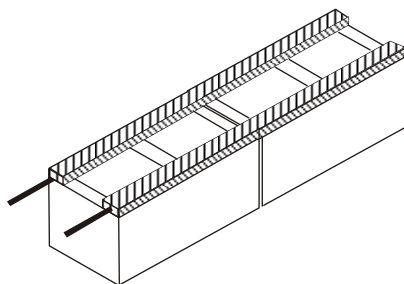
b. Colocación de refuerzos de acero en las juntas.
